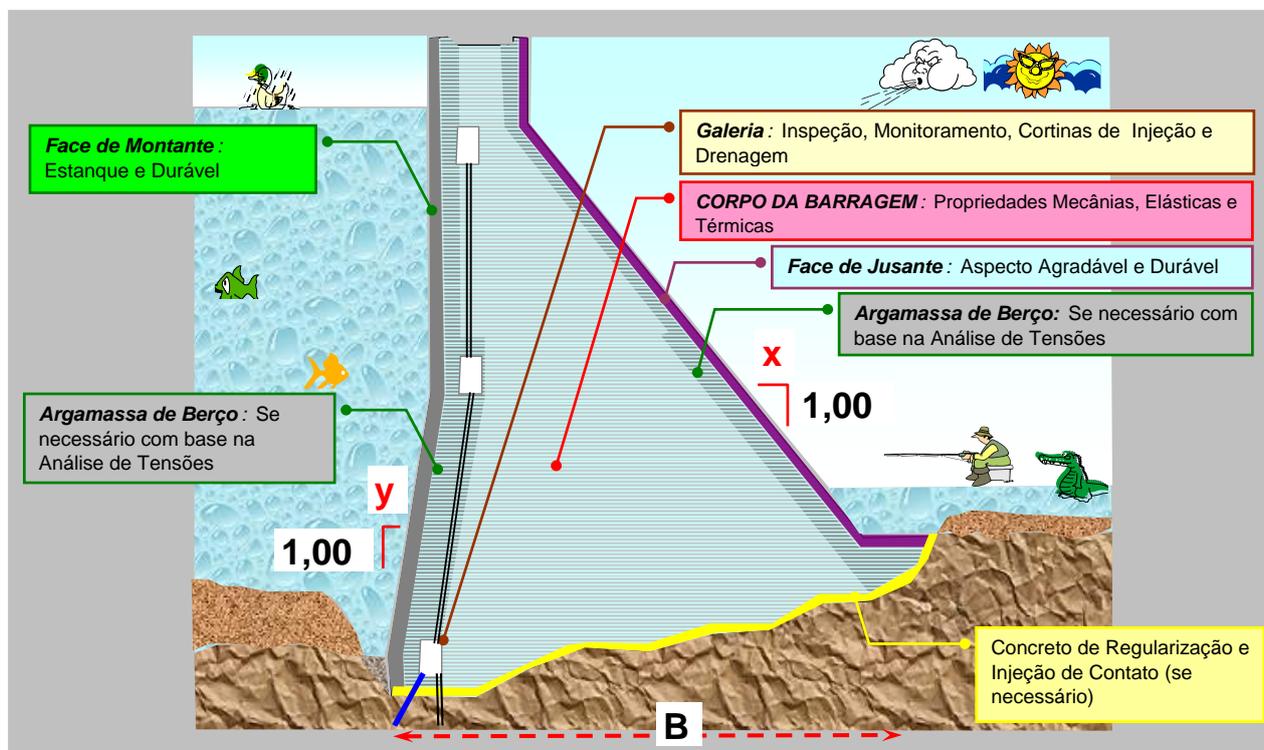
Aspecto esquemático sugerido para uma seção transversal considerando a aplicação de solo-cimento em barragem
